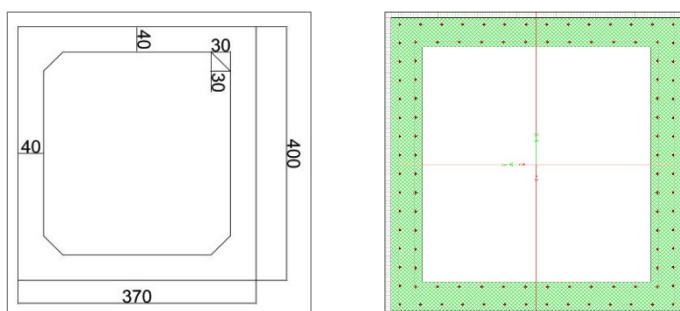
Dimensiones y distribución de refuerzo del travesaño superior en la pila del tramo de las dovelas de concreto.
